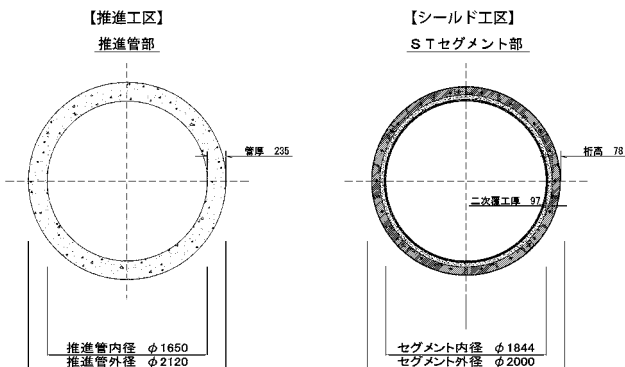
二次覆工併用型の施工断面(仕上り内径1,650mm)
